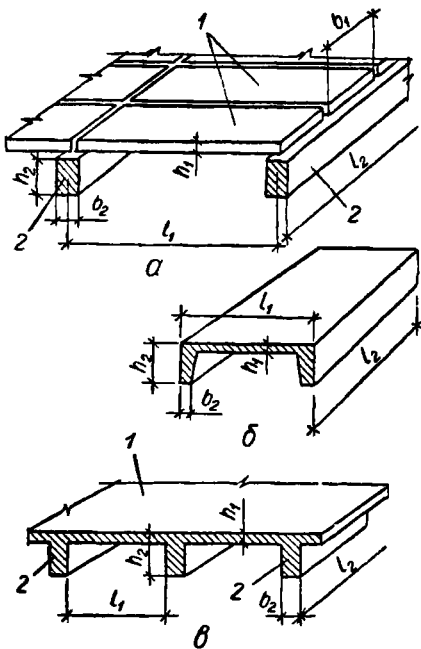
Конструкції залізобетонних елементів, що працюють на згинання: а — збірне перекриття; б — збірна плита; в — монолітне перекриття; 1 — плита; 2 — балка
